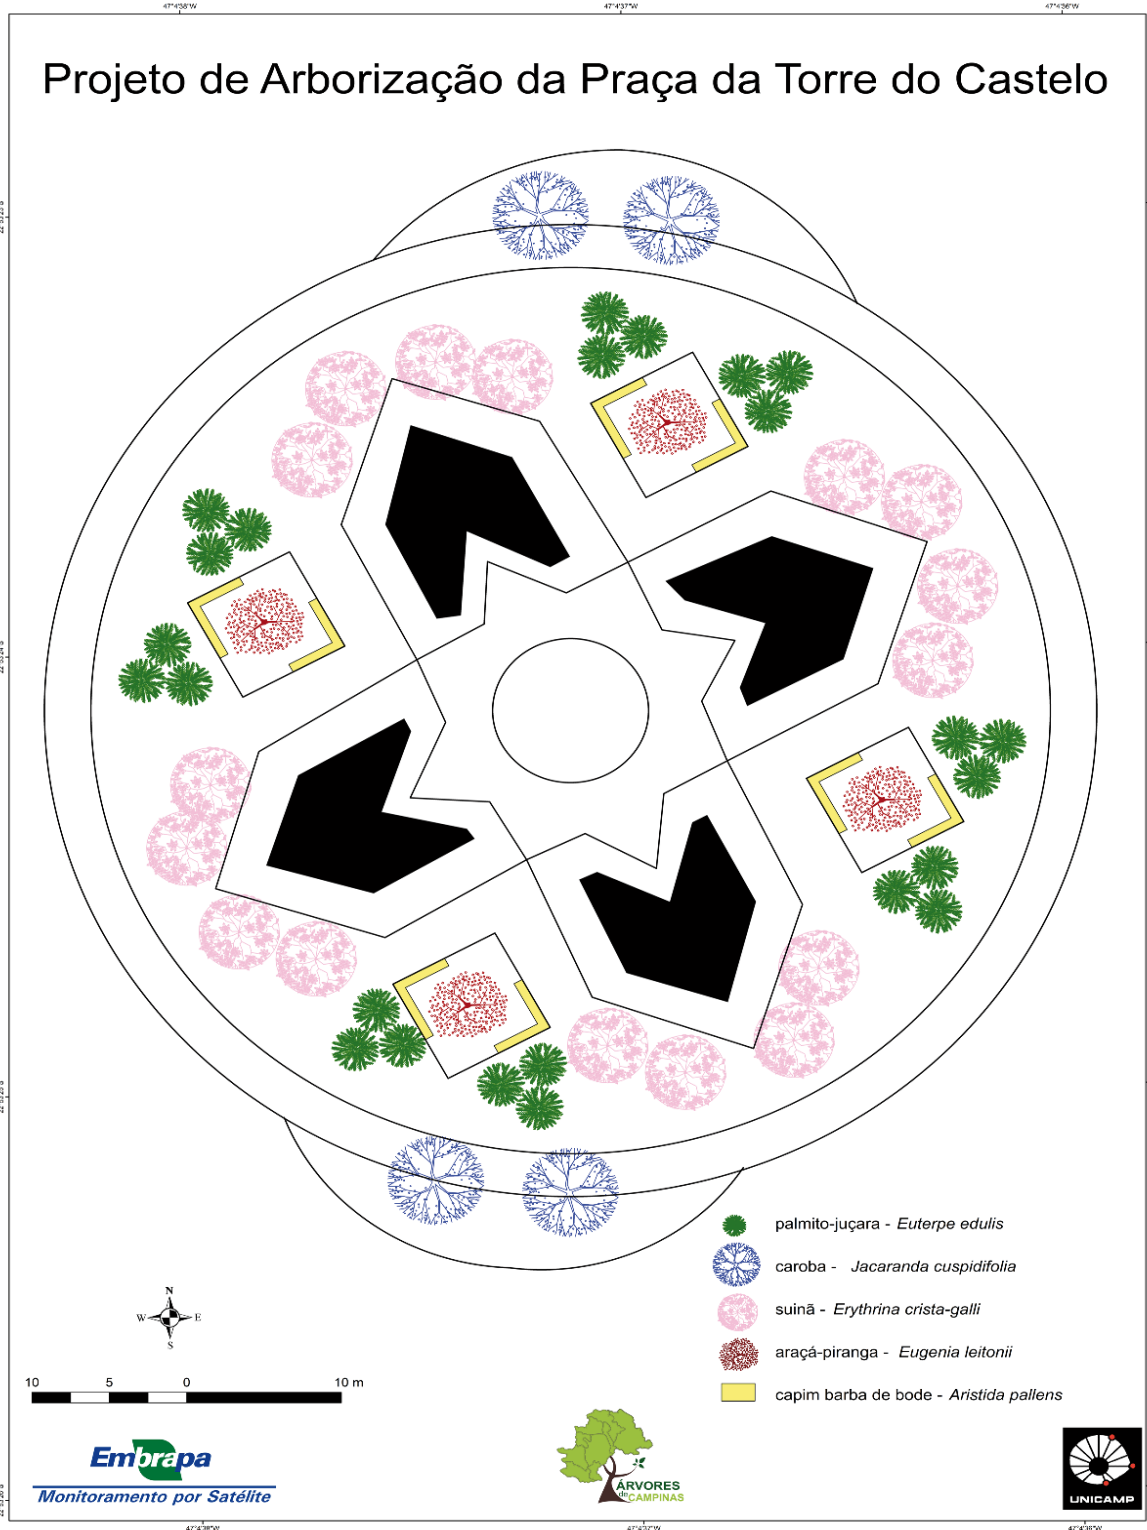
Planta baixa do projeto para rearborização do Balão do Castelo.
